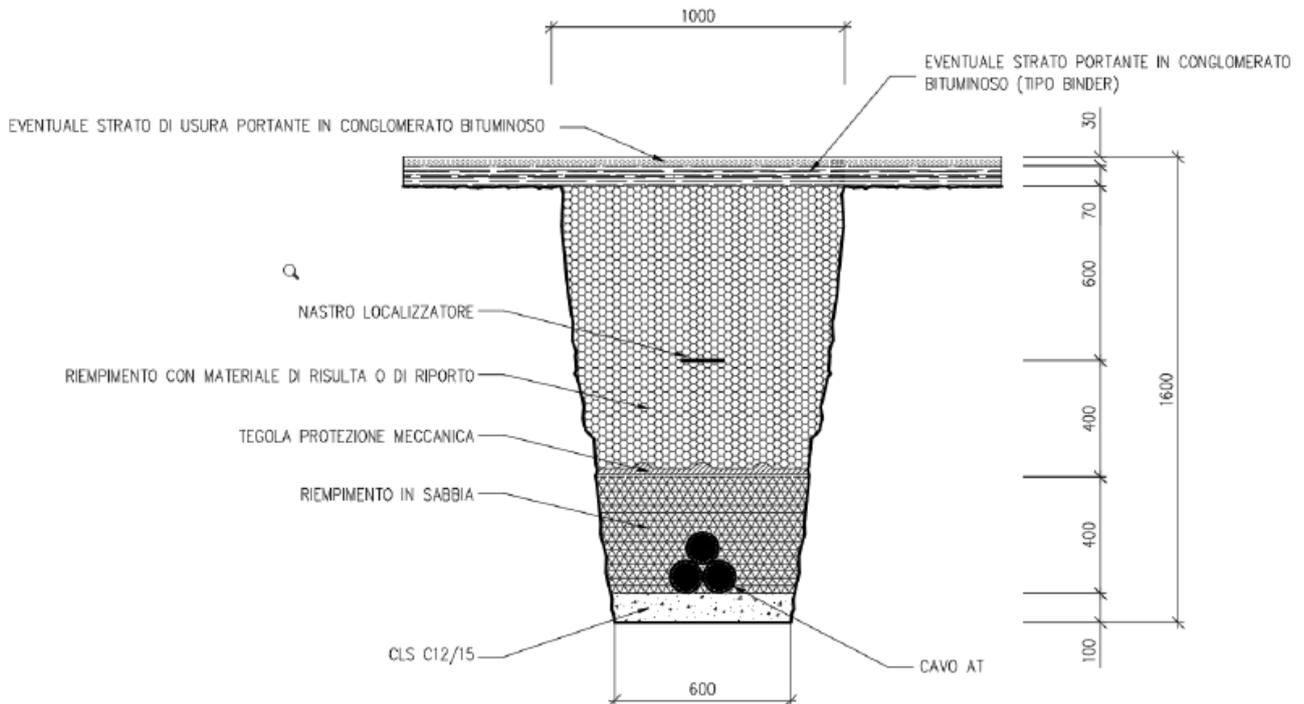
Dettaglio sezione di scavo per posa cavo AT
